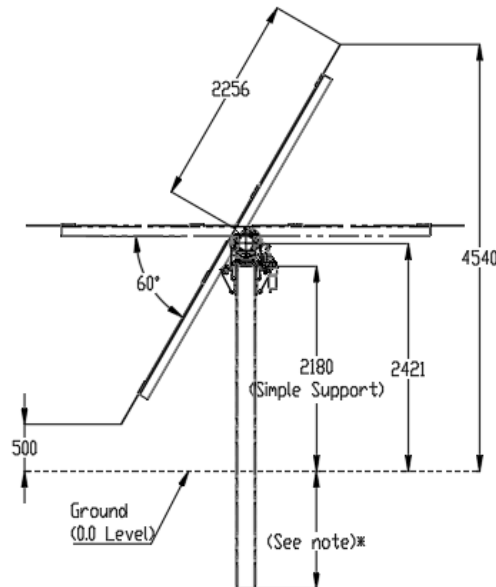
Dettaglio dimensioni strutture (Tracker)
